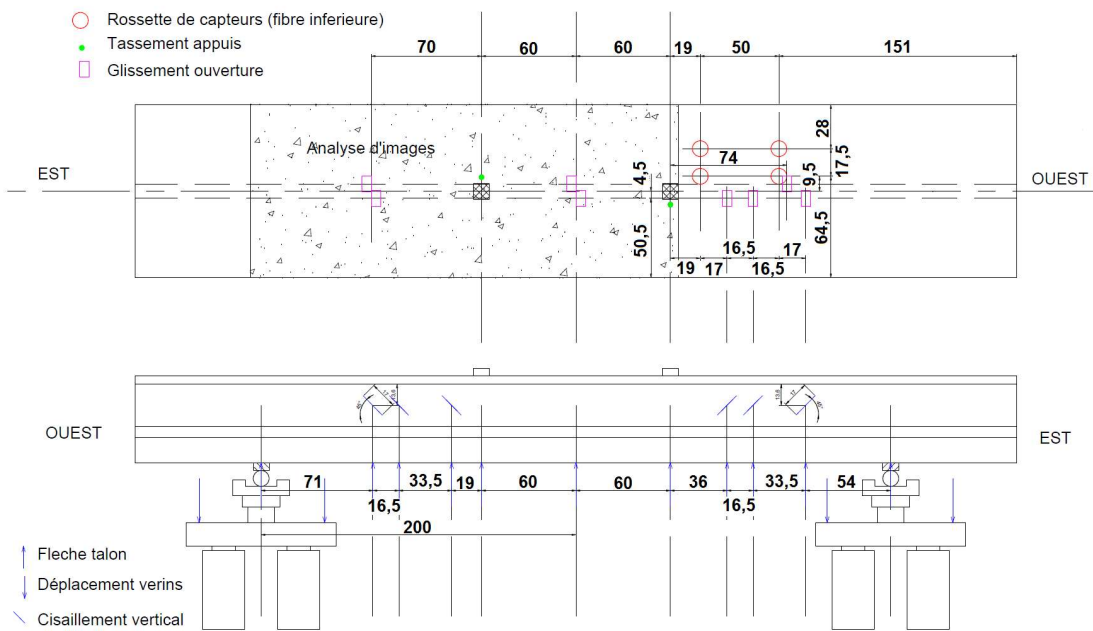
Plan d'instrumentation poutres BFUP A-B, BFUP C-A et BFUP C-B
